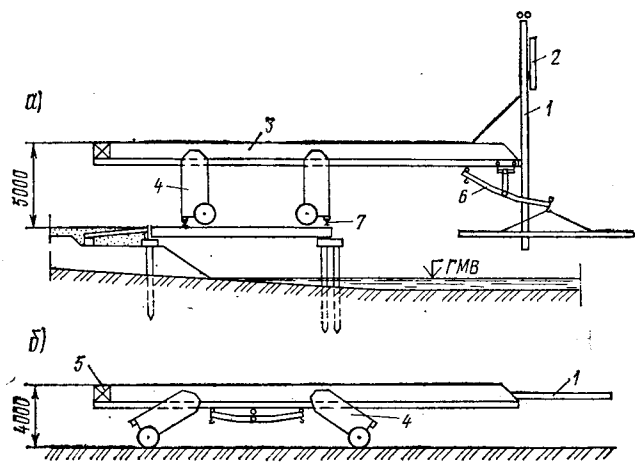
Агрегат для монтажа свайно-эстакадных мостов: а — в рабочем положении на поперечных колесах; б — в транспортном положении; 1 — копровая стрела; 2 — дизель-молот; 3 — ригель; 4 — опорные ноги; 5 — противовес; 6 — грузовая тележка с траверсой; 7 — поперечные инвентарные подкрановые пути
